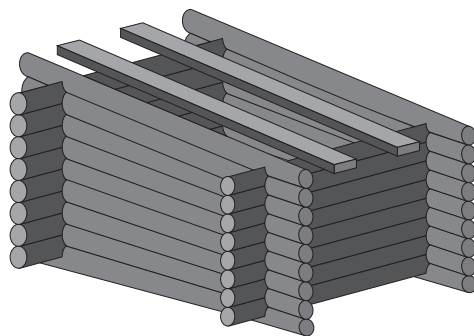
Перекрытие пог бесчердачную кровлю с использованием естественной конусности бревен
